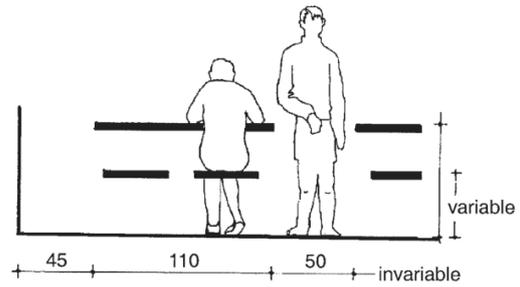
Cotes de passage minimale entre les tables (transversale)
